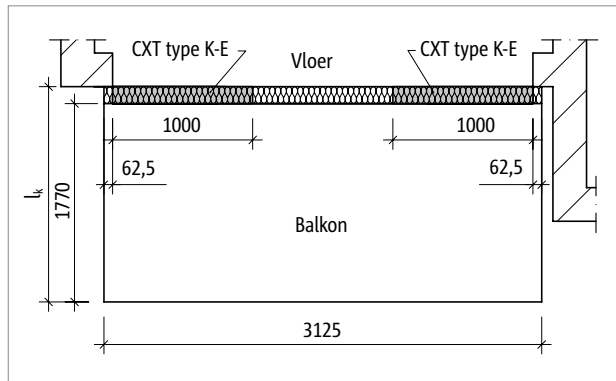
Schöck Isokorf® CXT type K-E: aansluiting van balkons met plaatdikten van 160 mm tot 200 mm met IDock2
